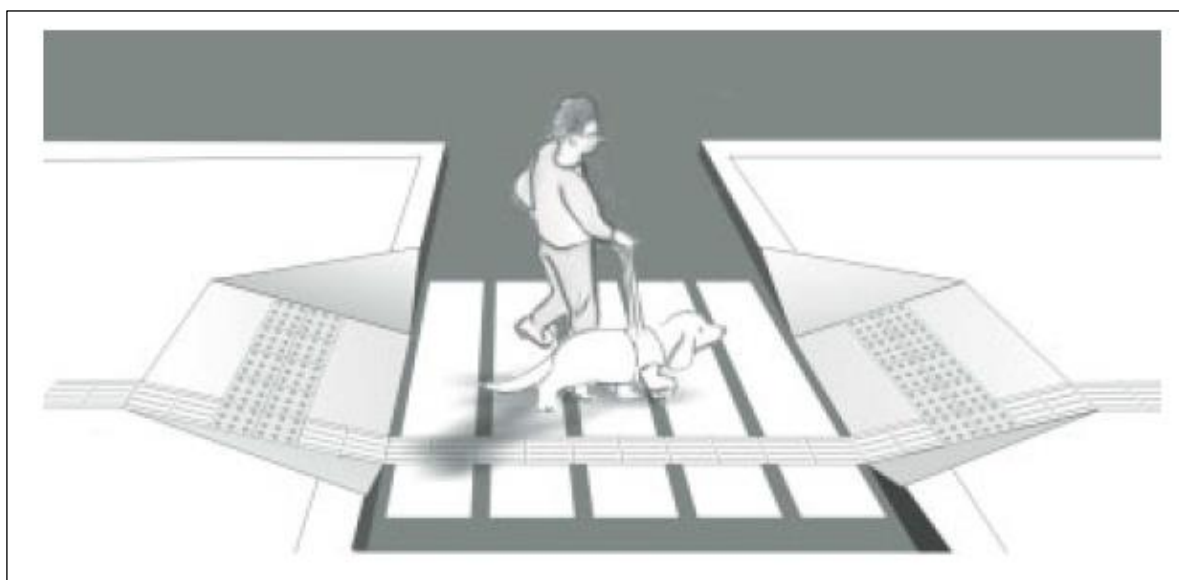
Rebaixamento de Calçadas - Vista Perspectiva
